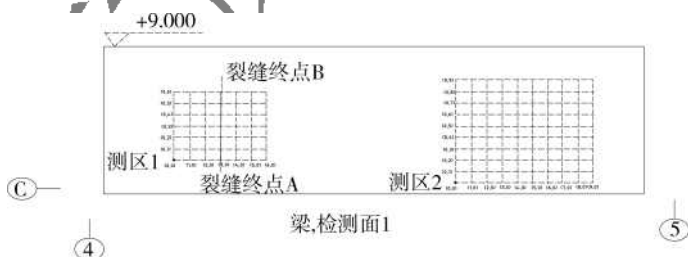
混凝土内部缺陷无损检测测区布置示意图
